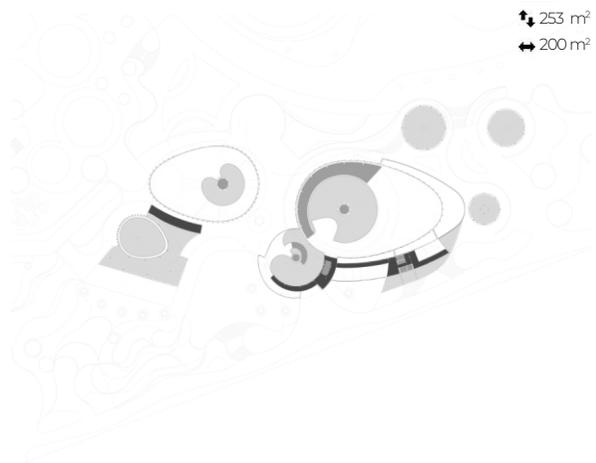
Flächennachweis. OG1-OG2 Grundrisse, Niveau 0,00 (+4,10)
